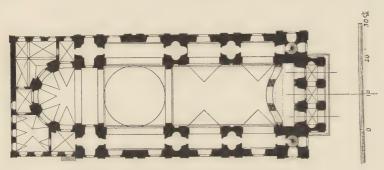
Jefuitenkirche zu Mannheim. Grundriss.
